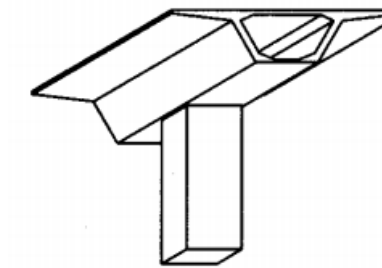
Fuste de sección cuadrada/rectangular para vigas artesa.
